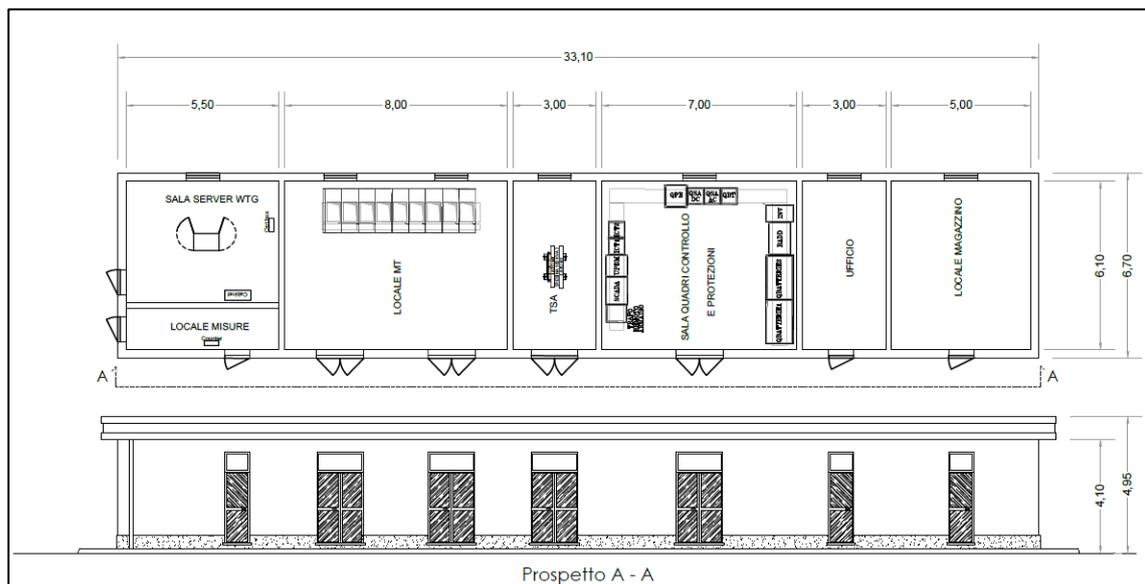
Pianta e prospetto dell'edificio della stazione di utenza
